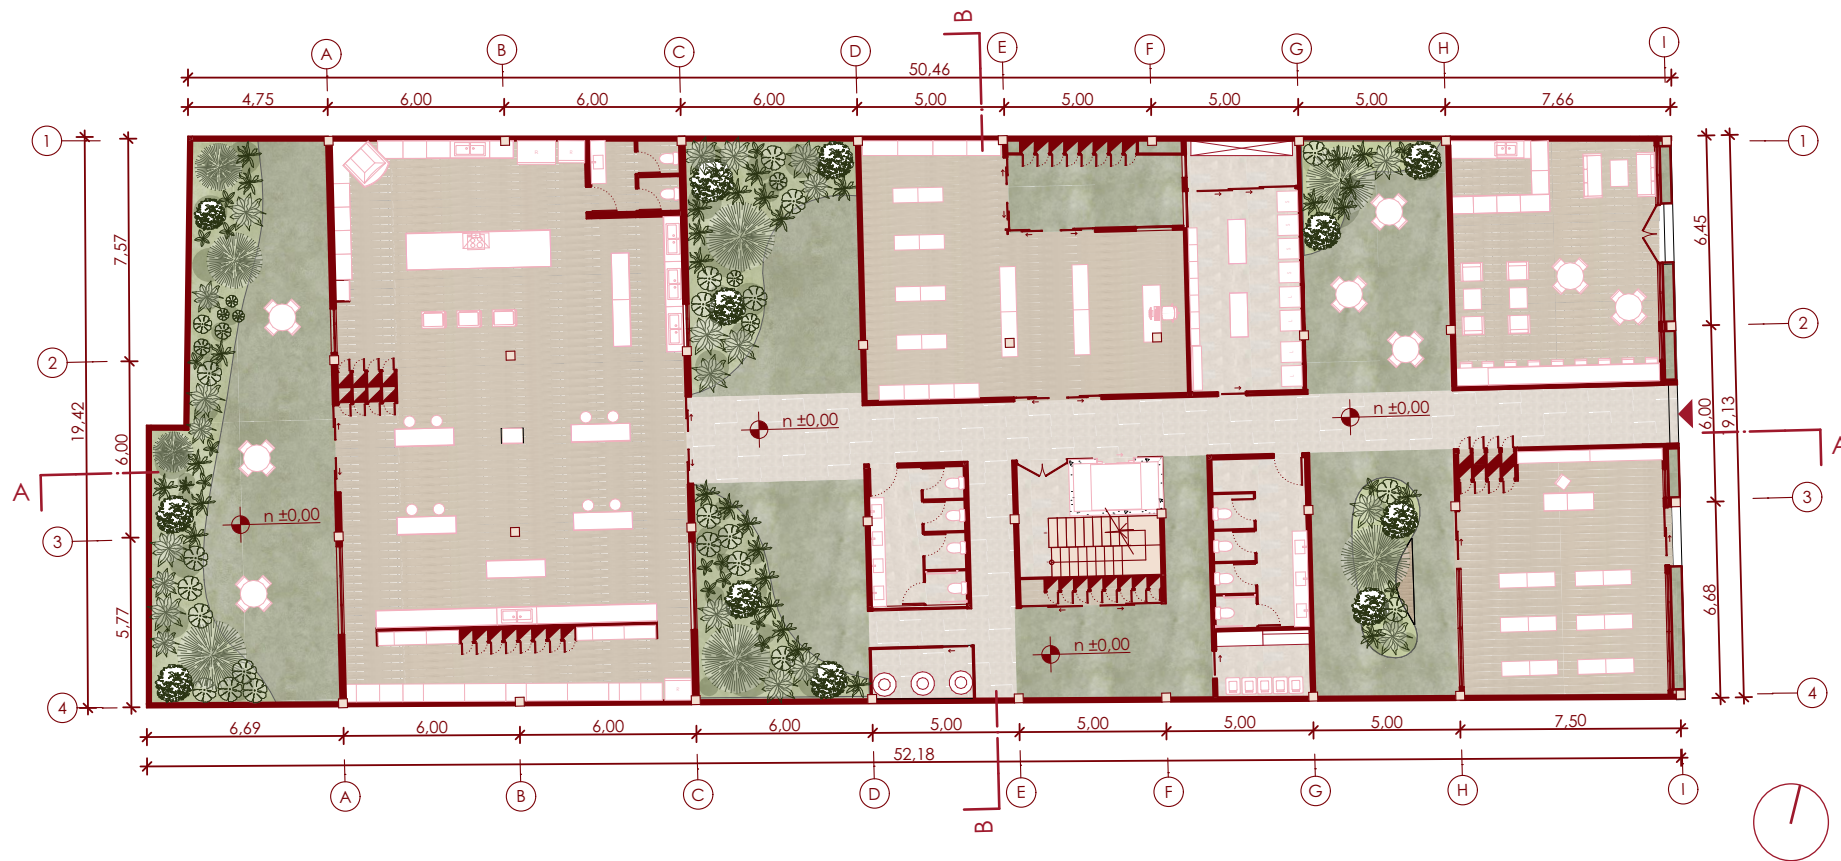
Planta baja del proyecto. Nota. Elaboración propia.
